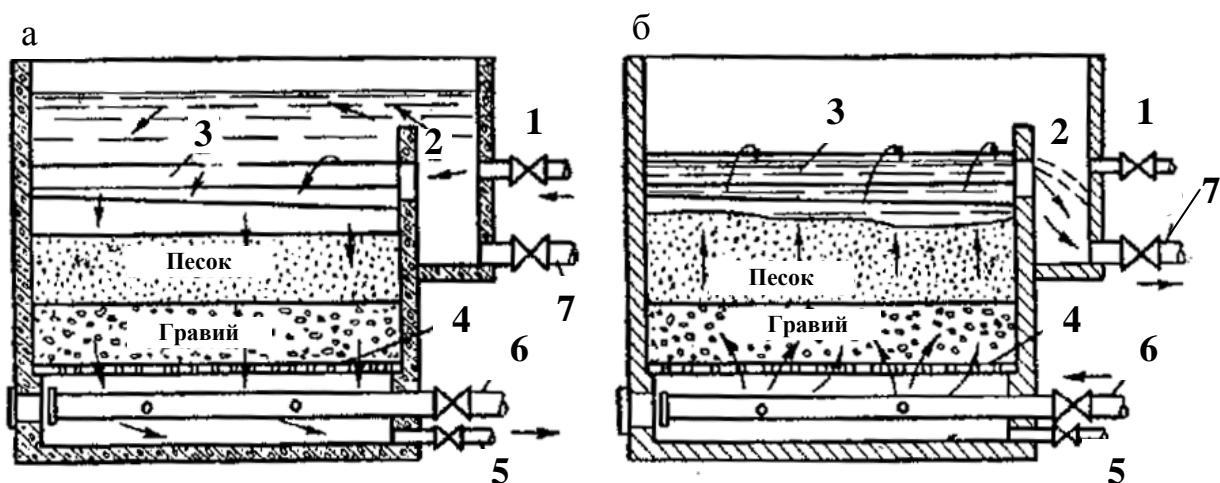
Схема скорого фильтра: а – при фильтровании; б – промывке: 1 – труба; 2 – лоток; 3 – желоба; 4 – днище; 5–7 – трубопровод
